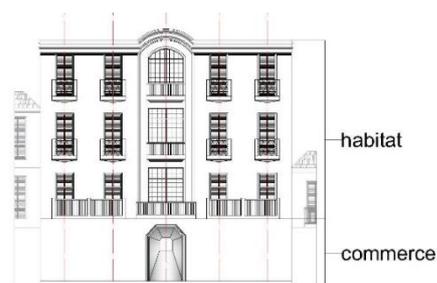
Façade du Bazard Esserdouk fait par les auteurs
